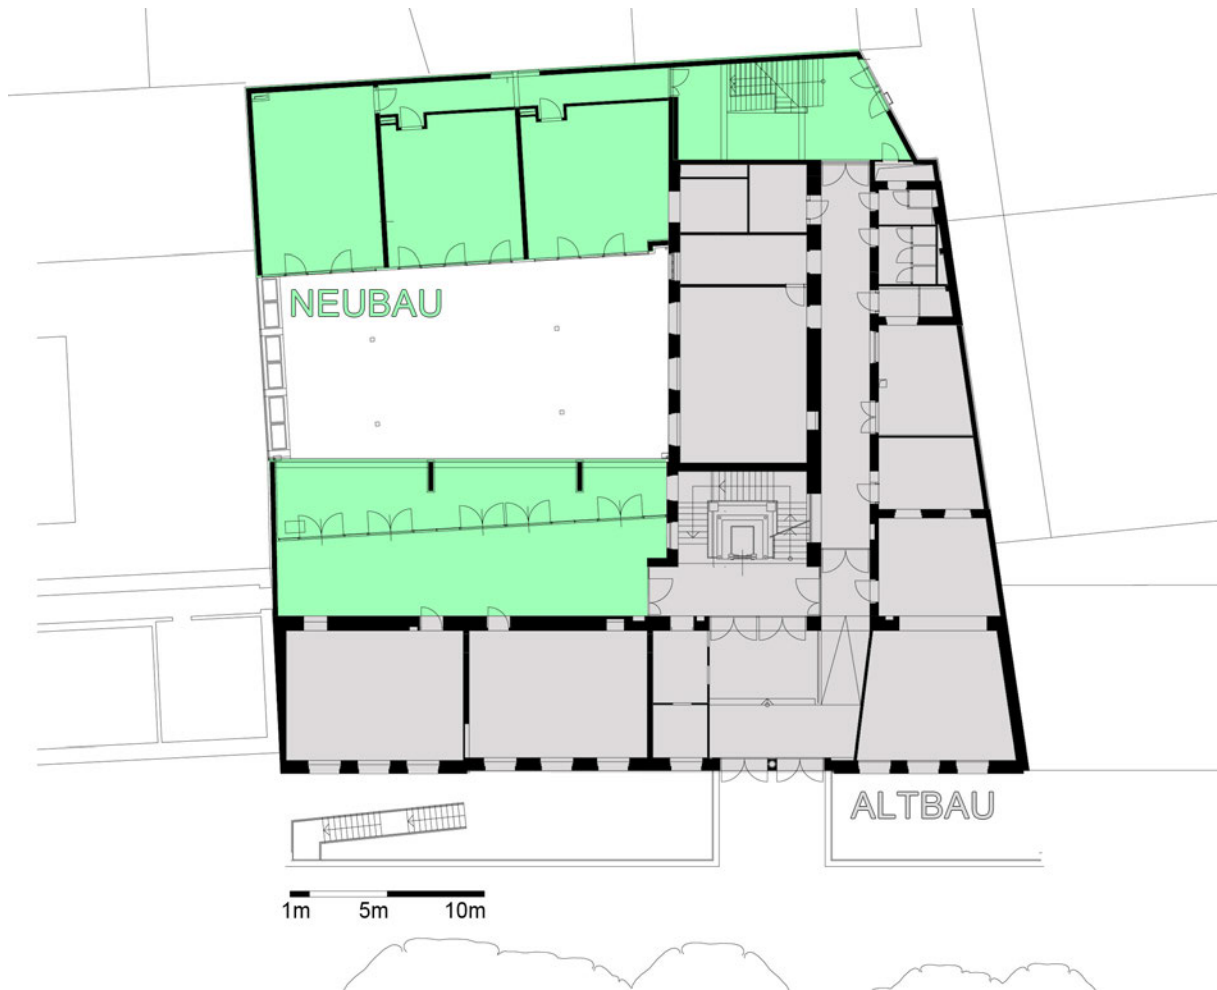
Erdgeschoß Grundriss. In grau Altsubstanz, in grün Neubau.
